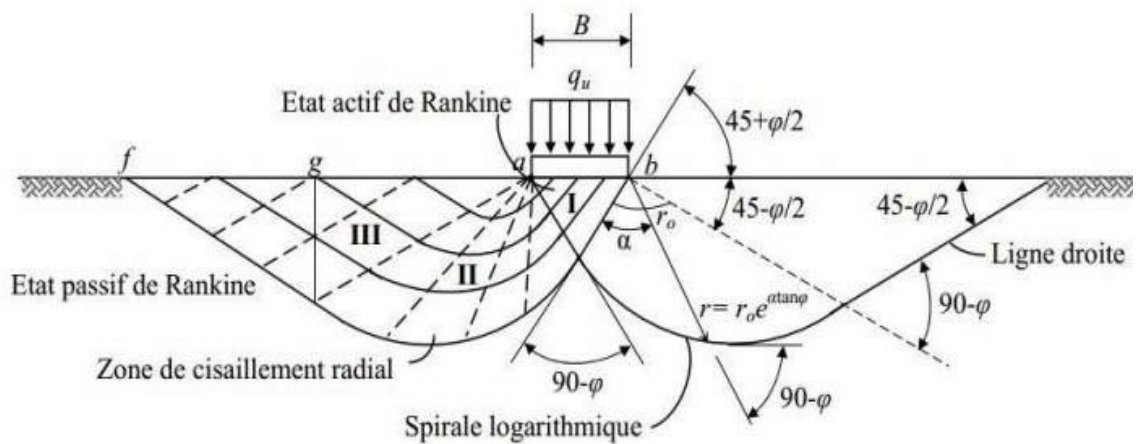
Zones de rupture sous la fondation, Prandtl (1920)
